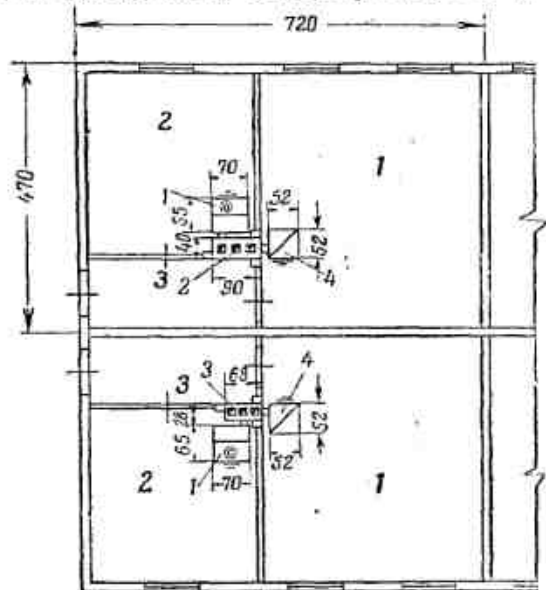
План дома к примеру № 1 расчета печного отопления:
